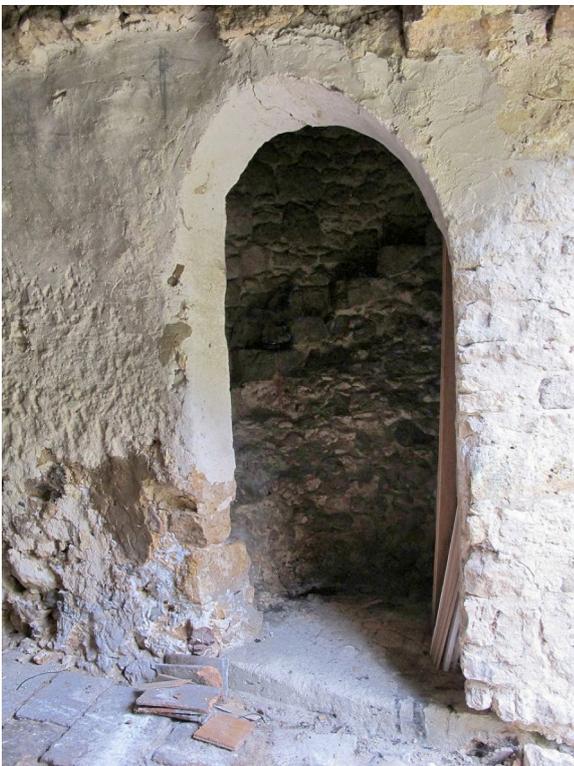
Tour T6 - Niveau 1 - Porte T6-16 ouverte vers la cage d'escalier en vis (Photo : Michel Piechaczyk / ADM).
